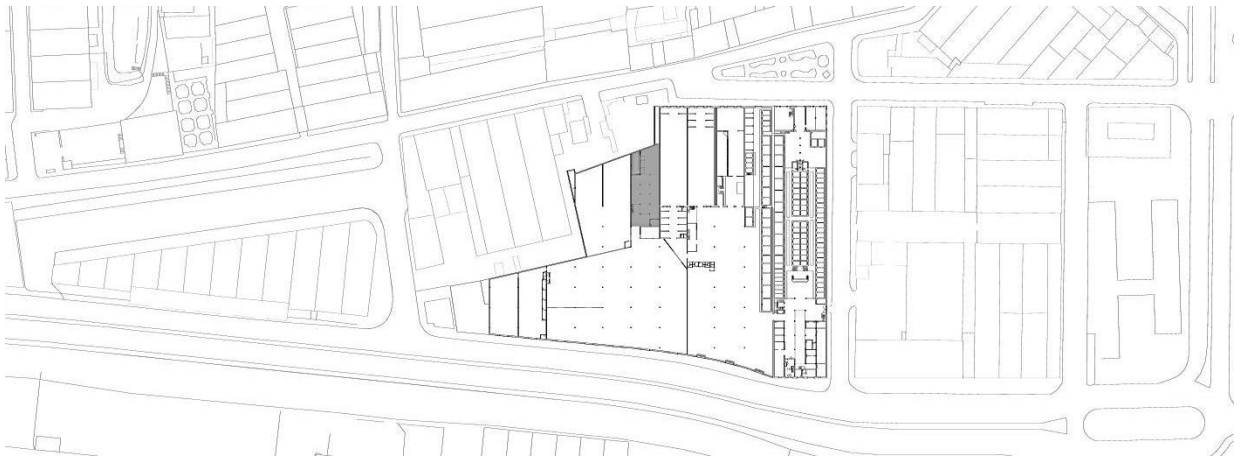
Planta de levantamento fotográfico piso térreo – Armazém 13.
